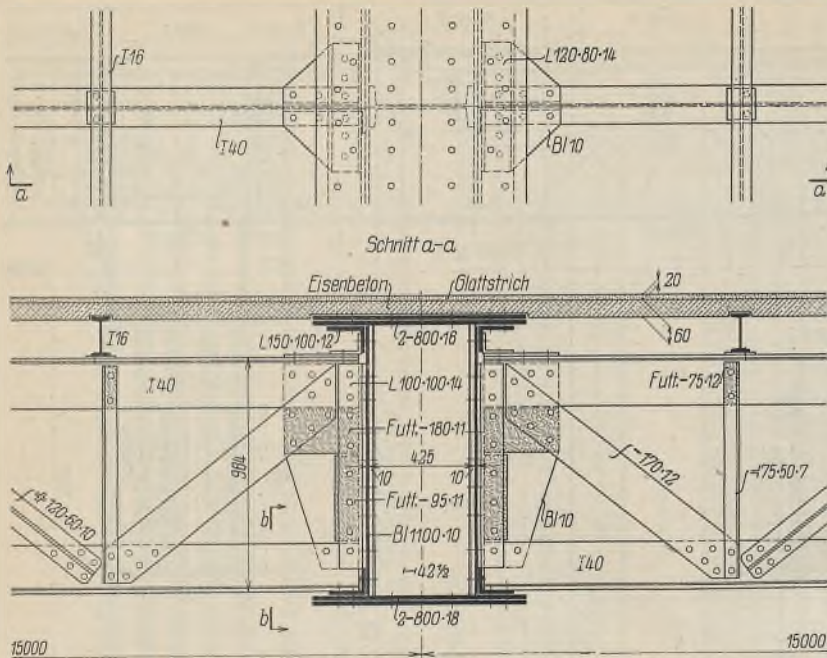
Anschluß der Fachwerkträger an den Kastenträger.
